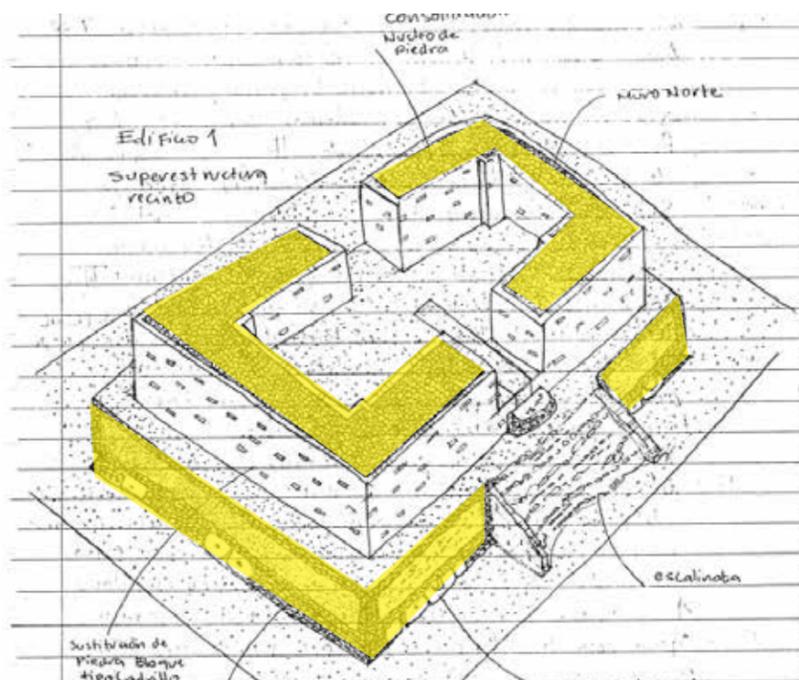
Dibujo Edificio 1 Cámara superior, reconstrucción del proceso de restauración. Acabados finales de restauración: en muros del recinto, piso interior de la cámara, basamento y escalinata central. Dibujo: GAMH 2002
